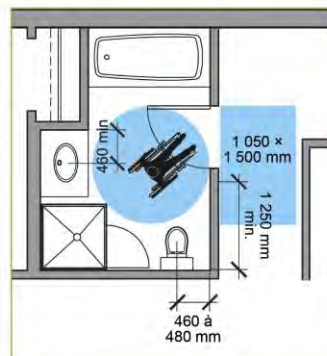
Dégagements dans une salle de toilette dans un logement minimalement accessible
